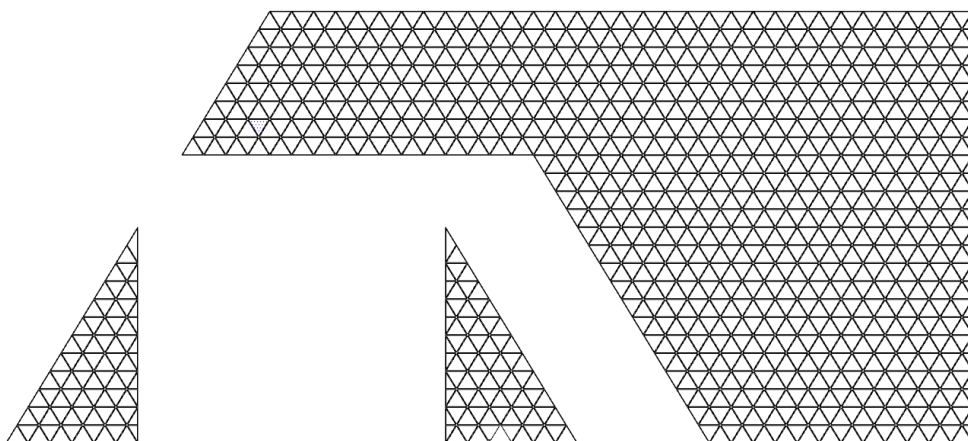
Plancha Perforada, Malla 1, Muro Acristalado, Fase 2
